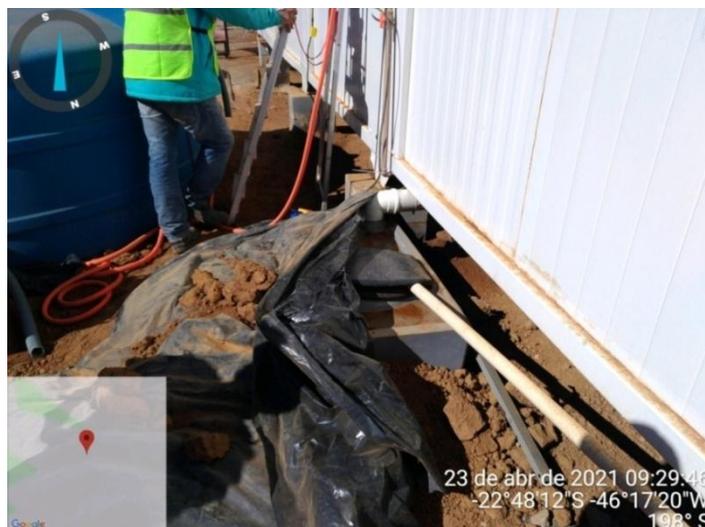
Caixa de armazenamento de efluente sanitário gerado nas instalações do canteiro de obras
